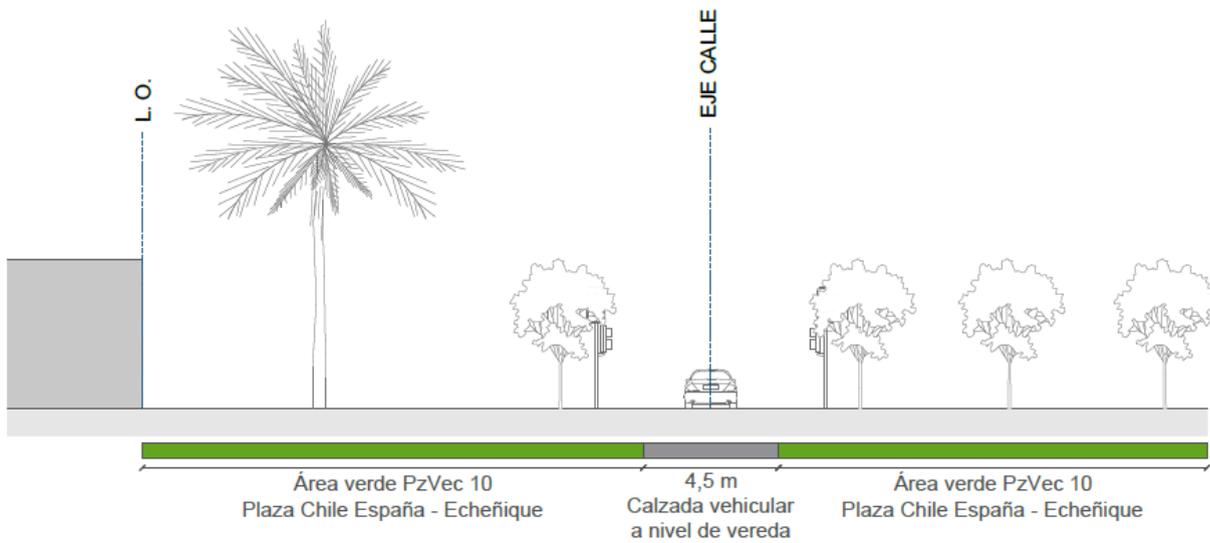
Perfil F-F'. Situación propuesta plaza Chile España - Echeñique.
